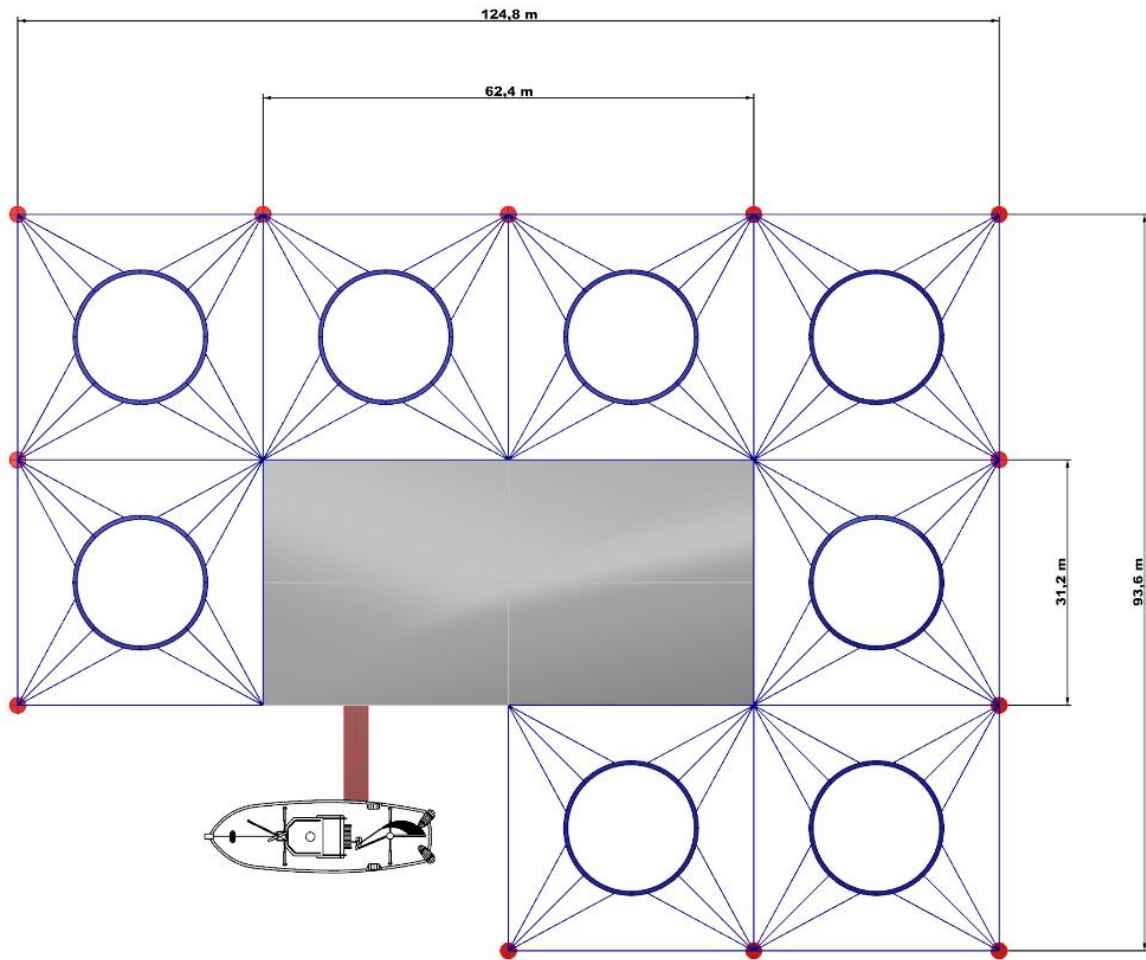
Dimensiones de la instalación. Fuente: Elaboración propia
